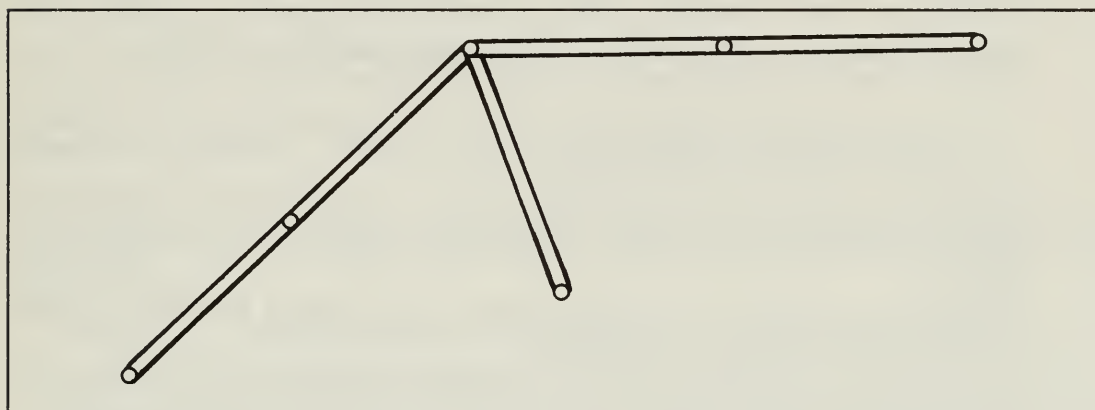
Assemblage d'ancrage à double empattement pour angles obtus dans des sols mous ou marécageux.
